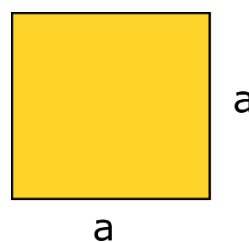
Définition de la hauteur et de la largeur, « a », pour les poutres en bois de section carrée
